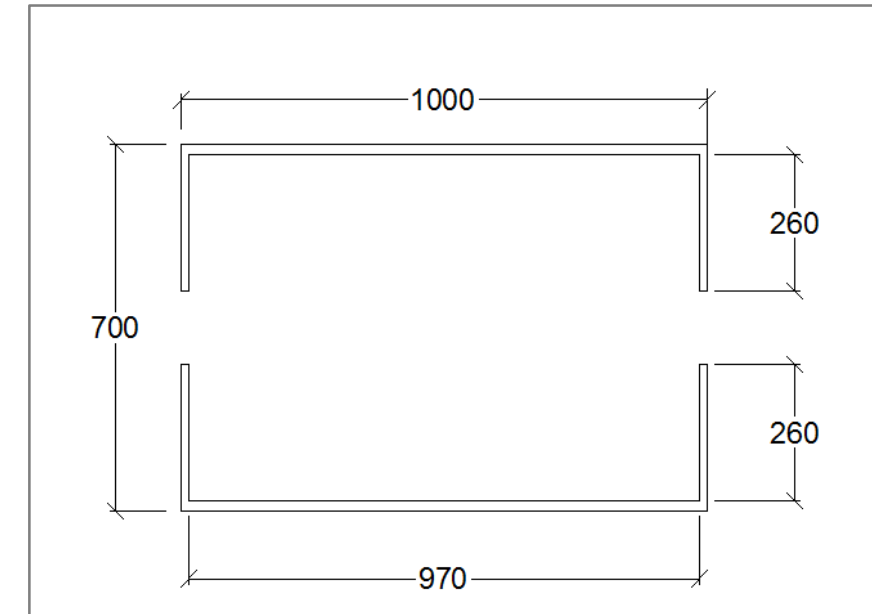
Sección reducida por flector de eje 2 en vigas longitudinales de pasarela (cotas en mm)
